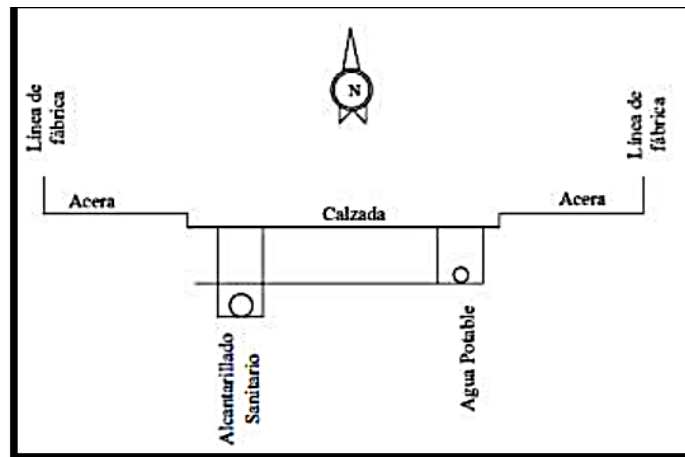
Ubicación de la Red de Sistema de Alcantarillado
